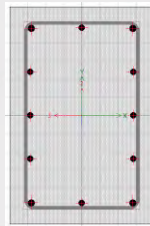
Refuerzo de la columna C-1 para sistema de muros
